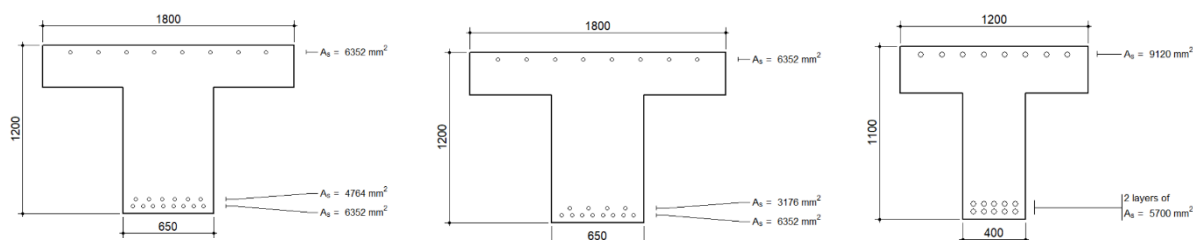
Armadura nas secções de vão: secção 2 (esq.), secção 4 (centro) e carlingas (dir.) [Anexo L]
